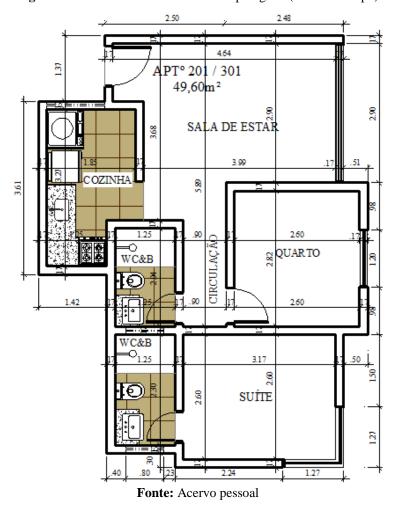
Planta Baixa de UHC de Tipologia 4 (Pavimento tipo)
